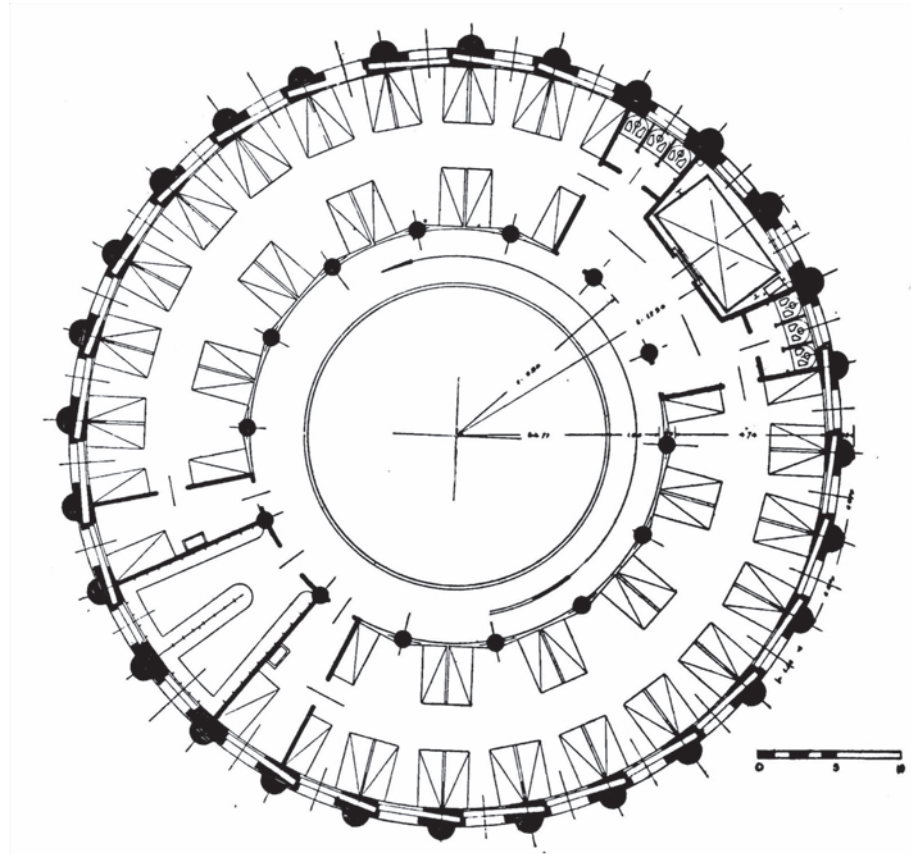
Fiat-Ferienkolonie „Torre Balilla“: Grundriss Rampengeschoß
